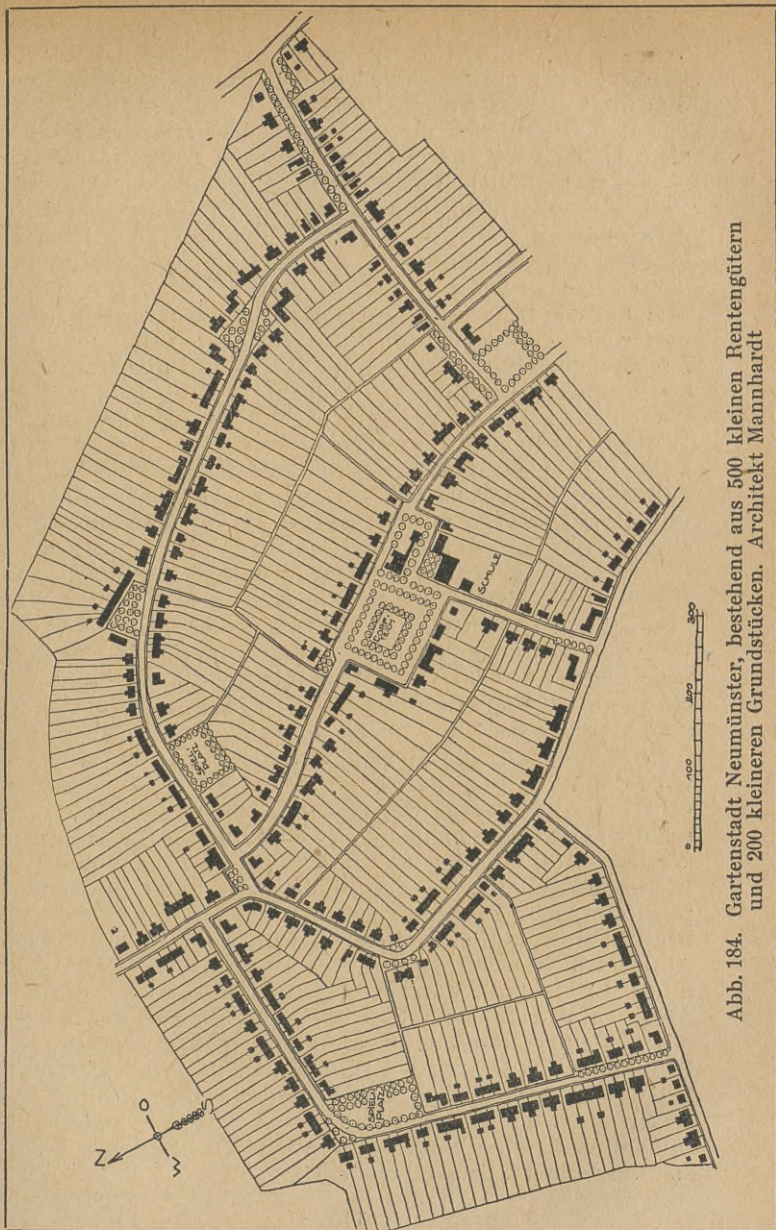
Gartenstadt Neumünster, bestehend aus 500 kleinen Rentengütern und 200 kleineren Grundstücken. Architekt Mannhardt
